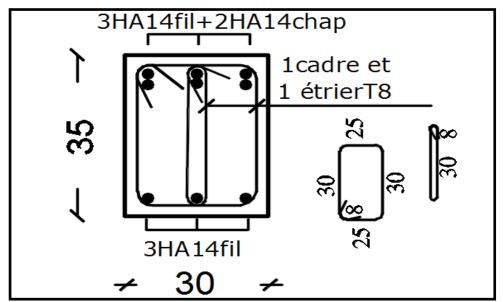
Ferraillage en travée d'une poutre secondaire.
